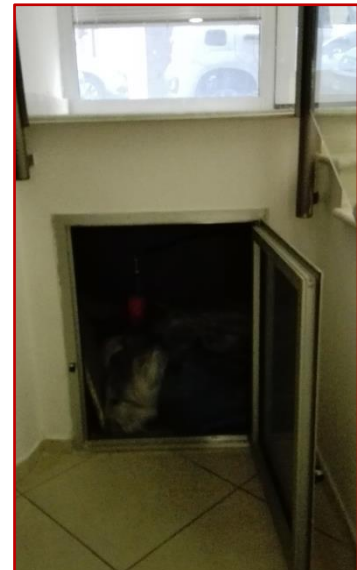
vano ispezionabile scarichi e dettaglio pavimenti
